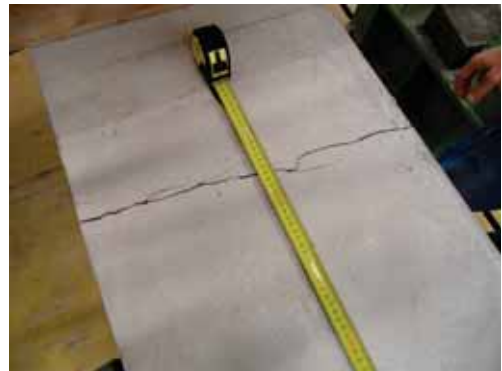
Betonriss im Bereich der Krafteinleitung F_A nach Maximalbelastung
